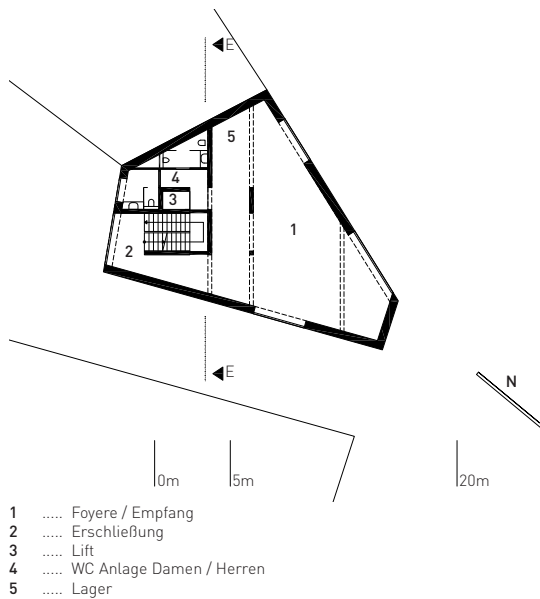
Grundriss Verwaltungsgebäude EG +0,00m
